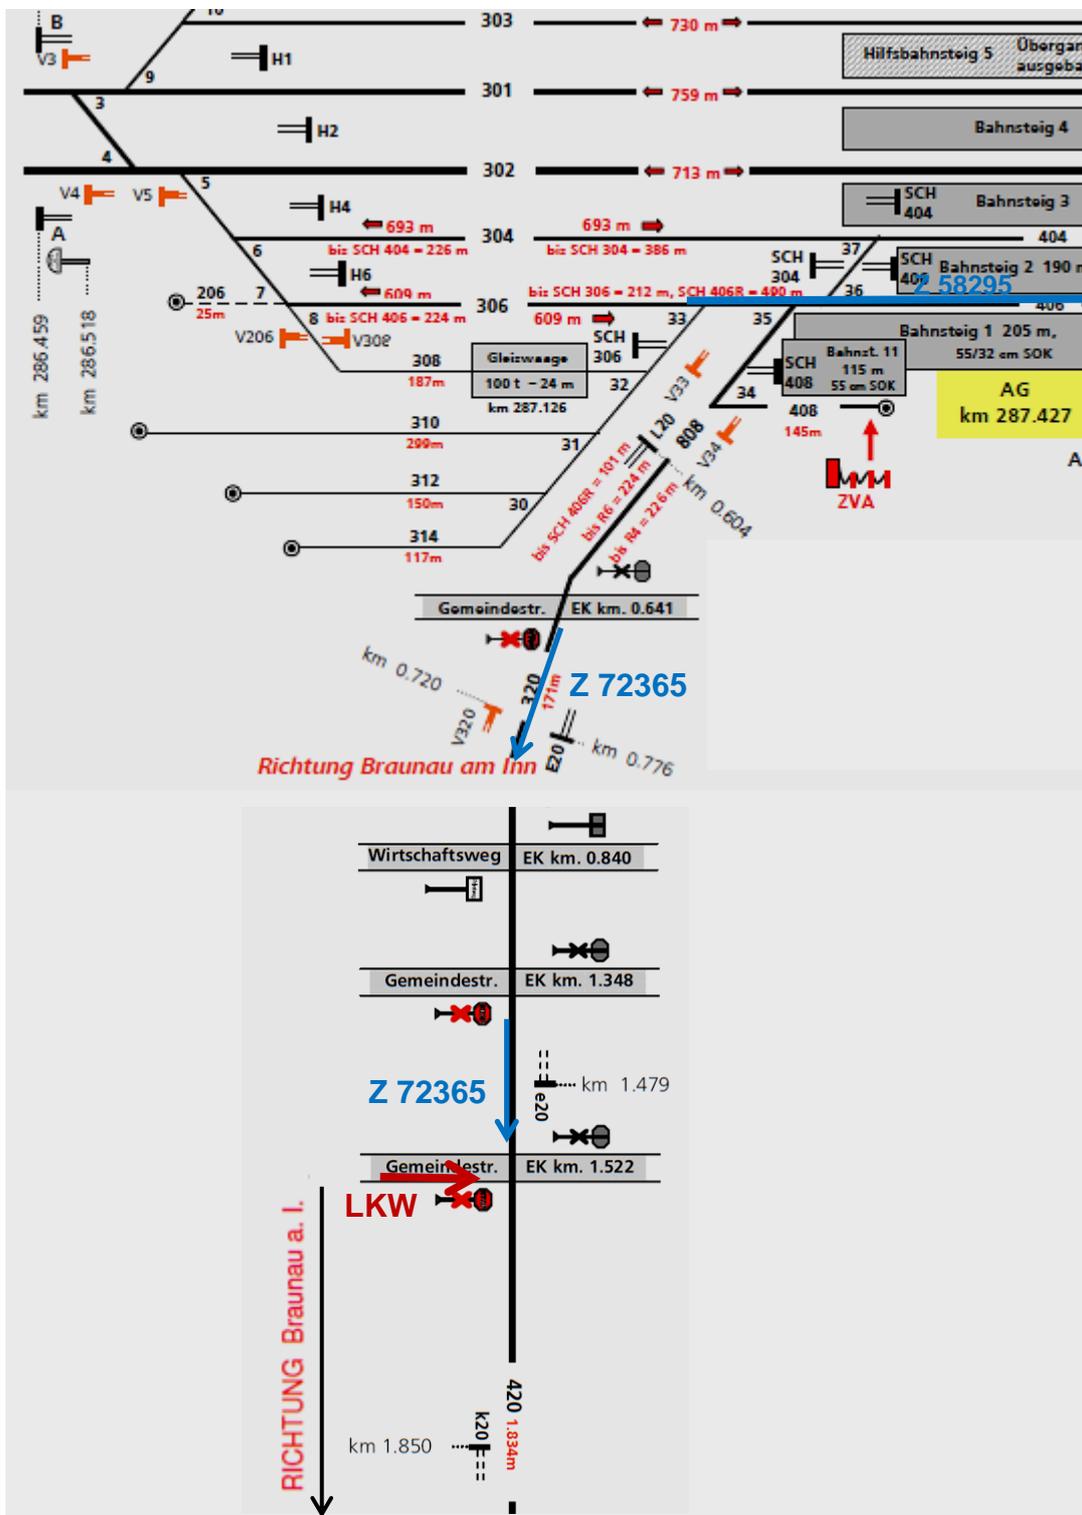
Lageplanskizzen Bf Steindorf bei Straßwalchen - Quelle IM
